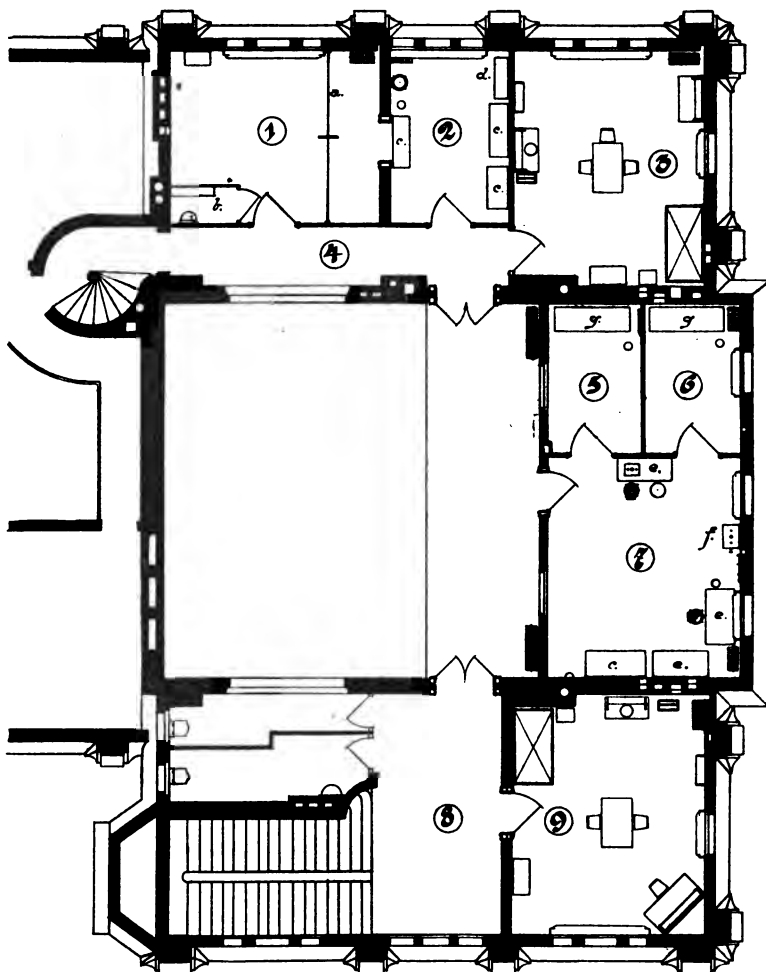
Abb. C I. Medic-klinisches Institut. Zweites Obergeschoss. Grundriss.
